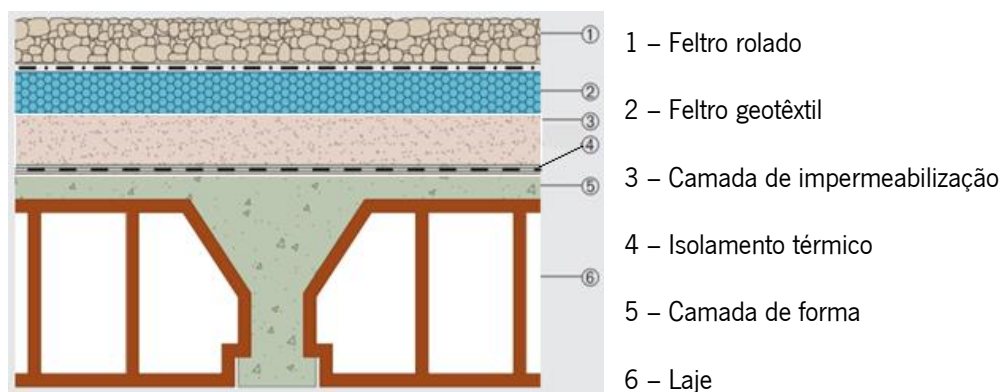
Pormenor construtivo tipo de uma cobertura plana tradicional (adaptado de (DOW , n.d.))
